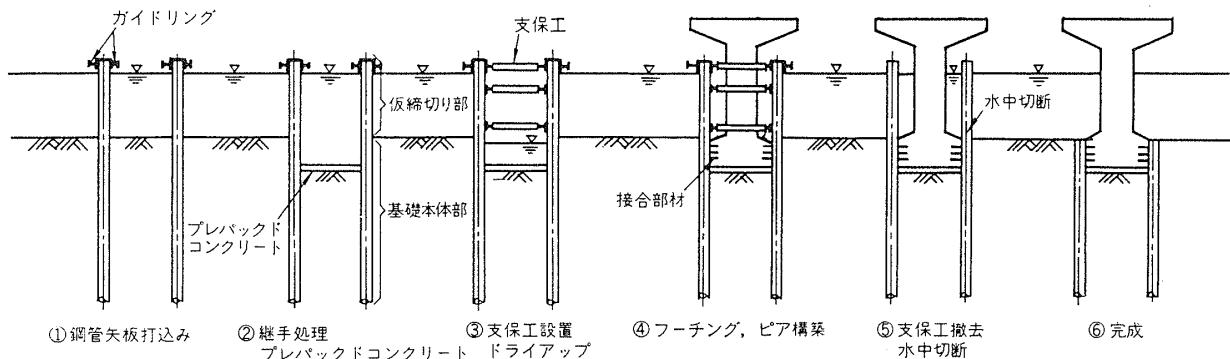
仮締切り兼用方式矢板式基礎の施工順序¹⁸⁸⁾
